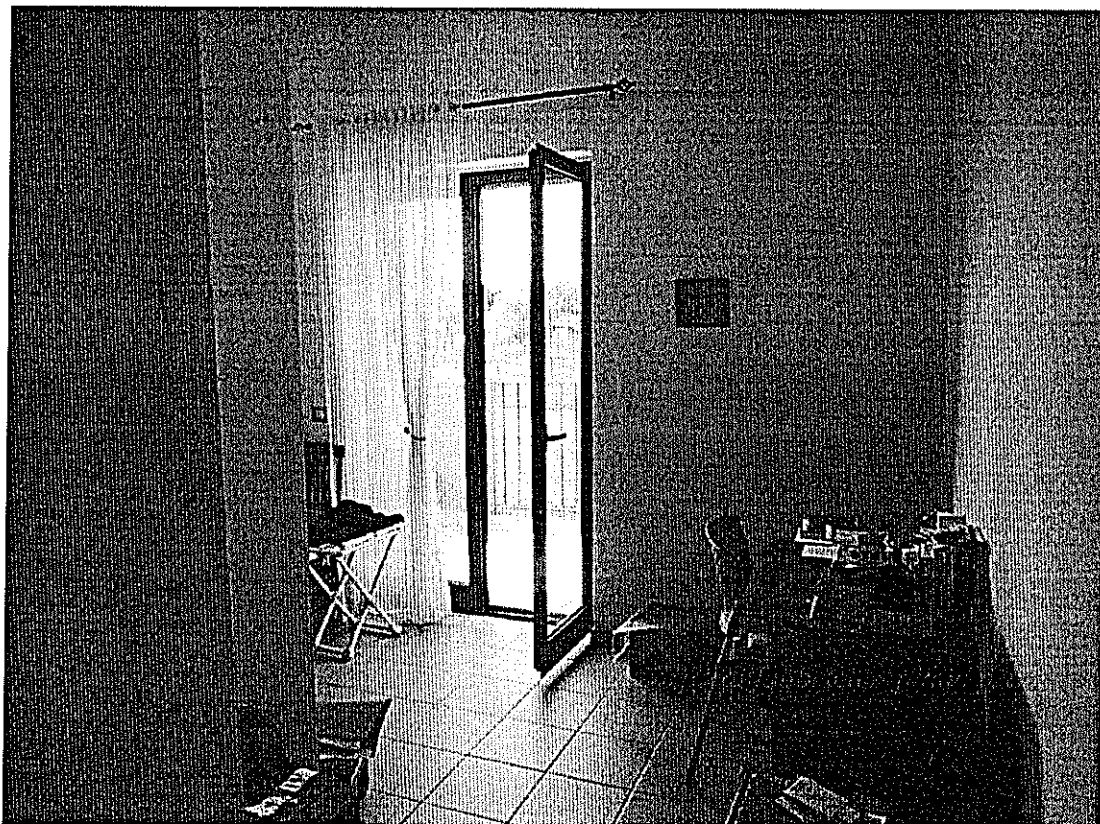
Camera tipo dell'ala sud del primo corpo di fabbrica – piano primo.
